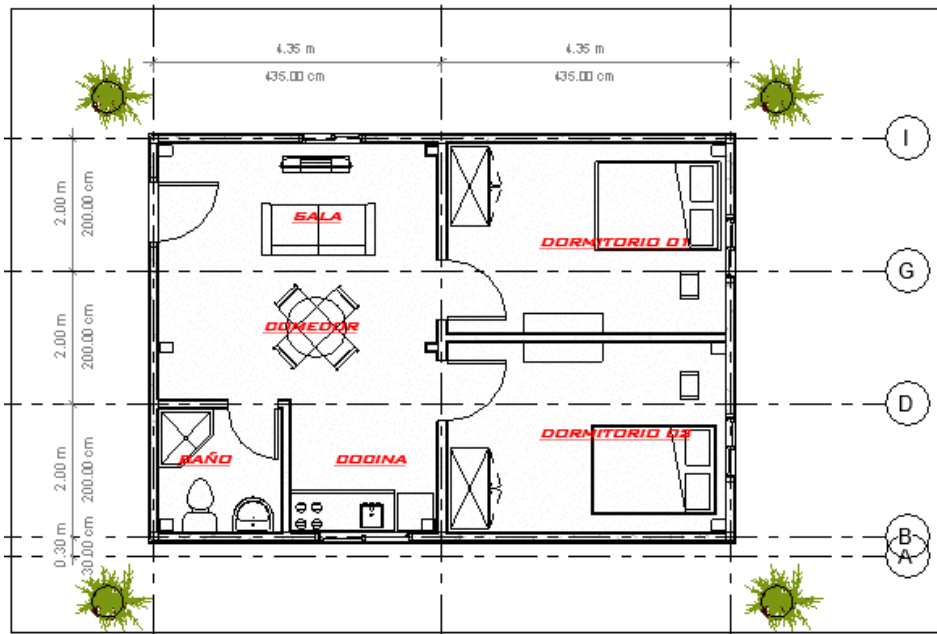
Vista en planta de distribución estructural y arquitectura para vivienda autosustentable, Elaboración propia (2021)
